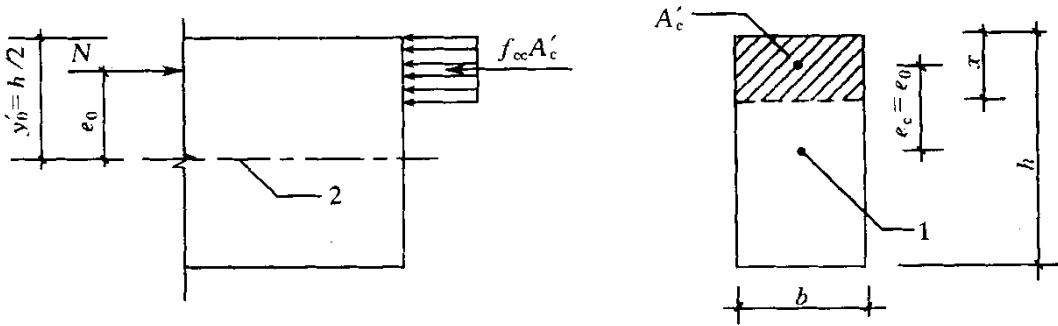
矩形截面的素混凝土受压构件受压承载力计算
